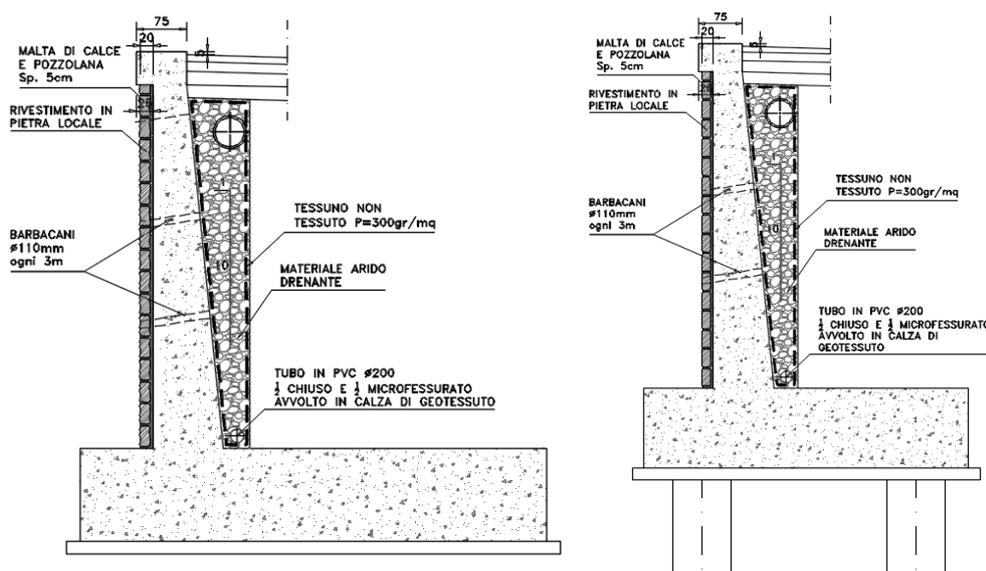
Sezione tipo muro di sostegno su fondazione diretta (a sx) e sezione tipo muro di sostegno su pali (a dx)
